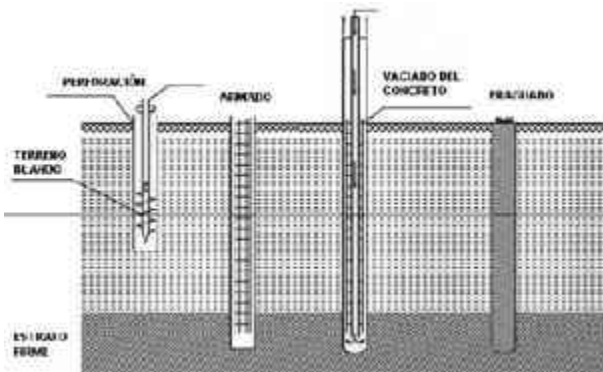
Proceso de construcción de los pilotes de concreto armado elaborados in situ.
